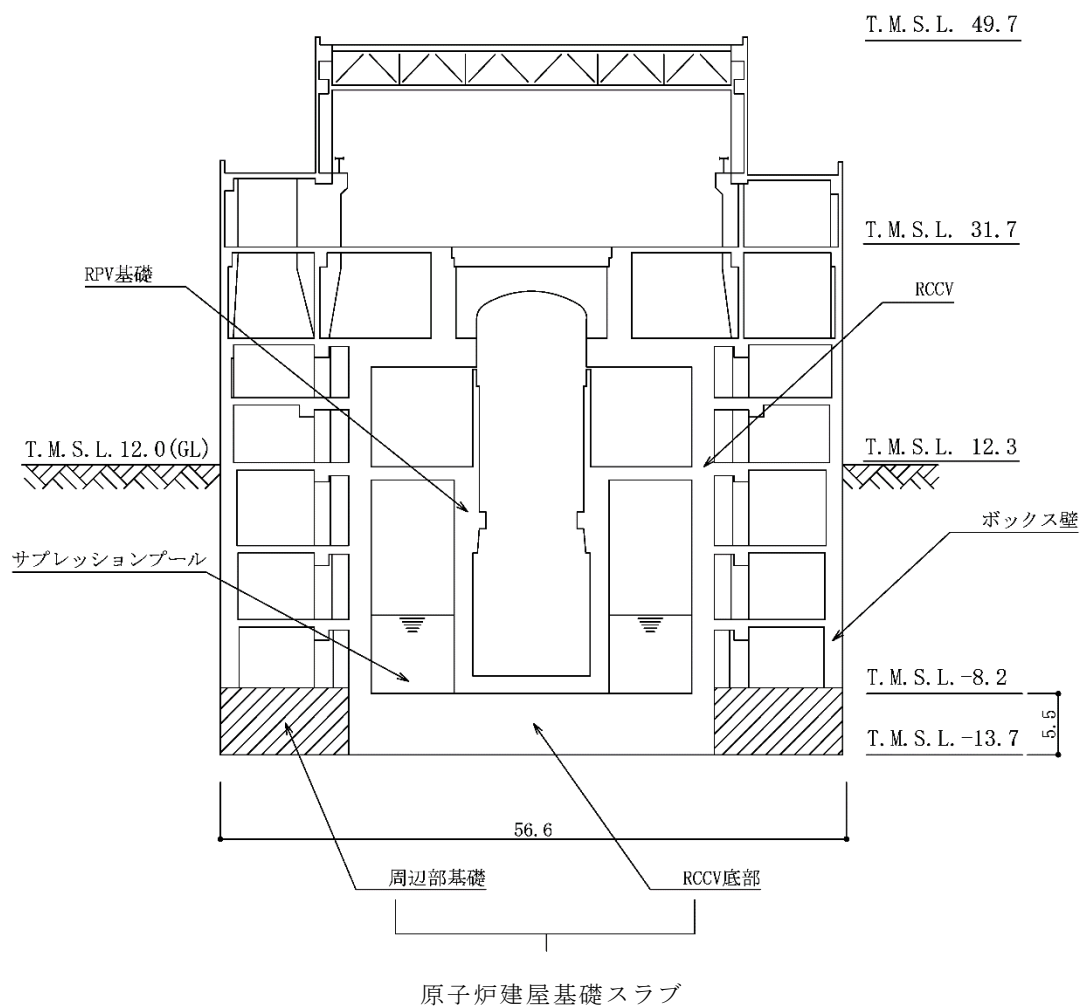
原子炉建屋基礎スラブの概略断面図 (A-A 断面) (単位 : m)
